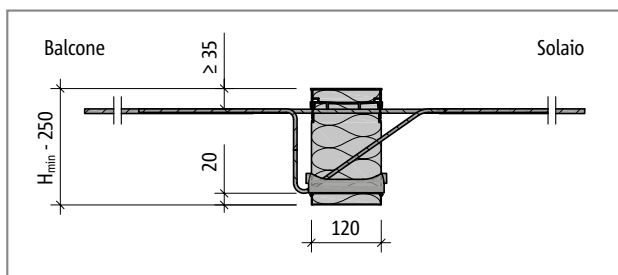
Schöck Isokorb® tipo da KXT55 a KXT100, REI120: sezione dell'elemento
